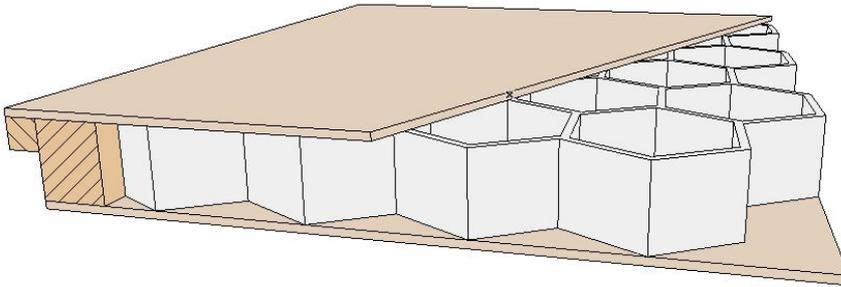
Schemaskizze einer Tür mit Wabenstruktur und Furnier-Deckplatten
